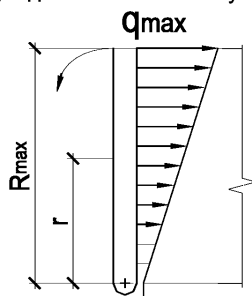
Расчетная схема давления для определения сцепления с бетоном прямоугольного участка опалубки
